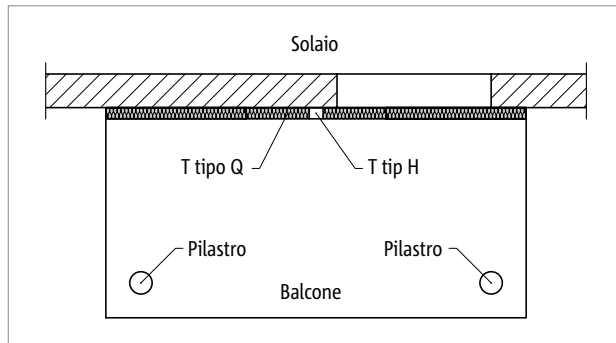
Schöck Isokorb® T tipo Q: balcone con appoggio su pilastri
